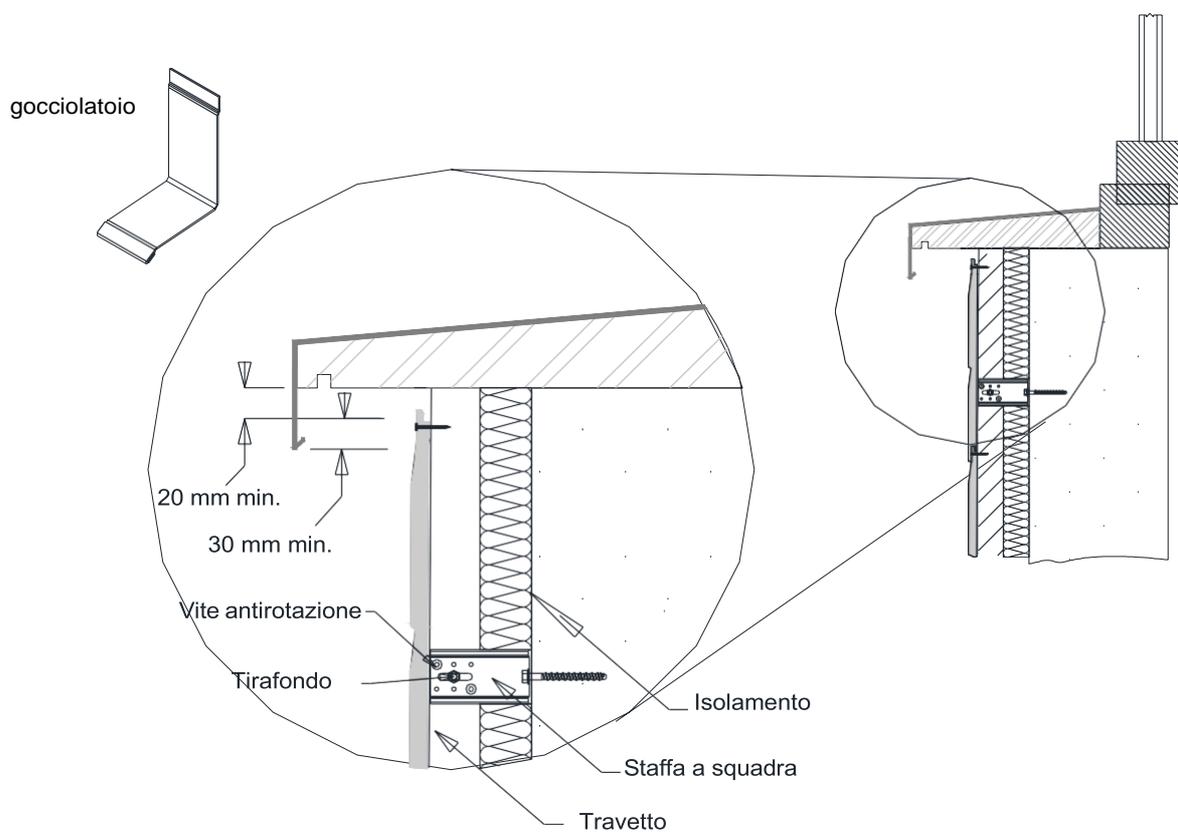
is - Sostegno - Posa in rivestimento (sezione verticale)
